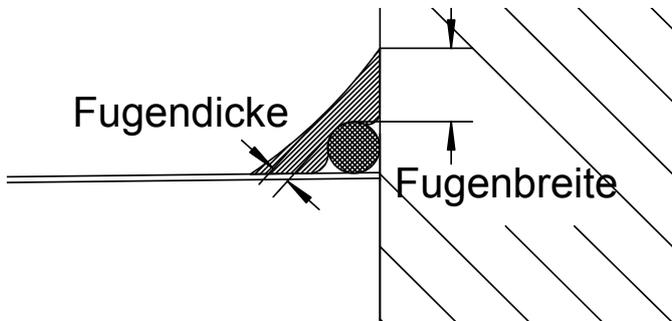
Richtige Ausführung einer Dreiecksfuge Quelle: BVRS
